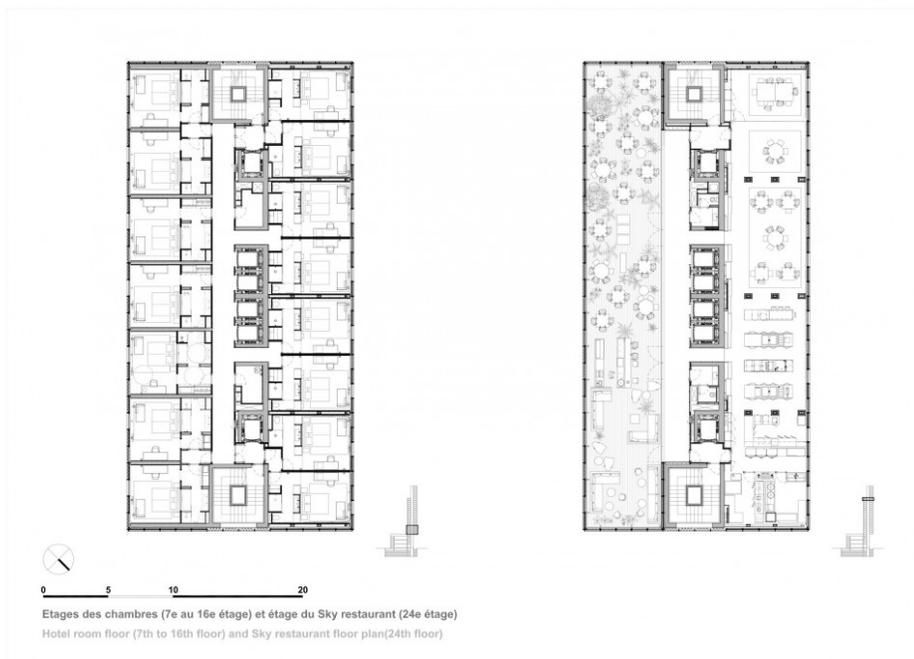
HOTEL ME BARCELONA – PLANTAS HOSPEDAGEM 7º AO 16º PAVTOS E RESTAURANTE 24º PAVTO
